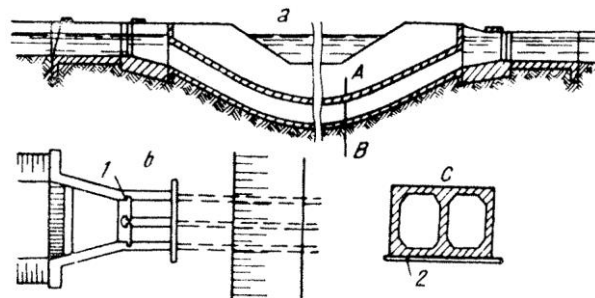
Dükere de beton armat (cu conductă dublă), din conducte cu secțiune dreptunghiulară, pentru subtraversarea unui curs de apă amenajat: a – secțiune longitudinală; b – plan; c – secțiunea A-B; 1 – nișa batardoului; 2 – beton.
